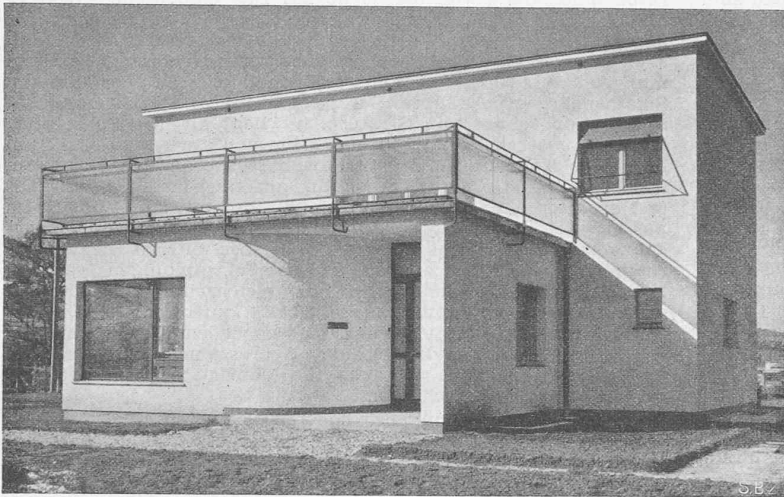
Landhaus «La Joliette» sur la Raisse, Bulle.
